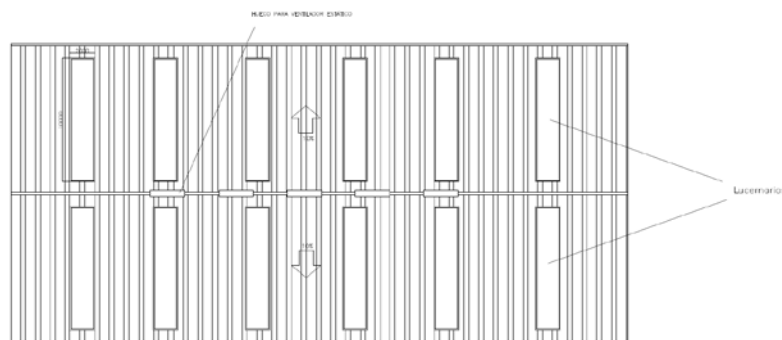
Cubierta edificio industrial, detalle plano 8.3
